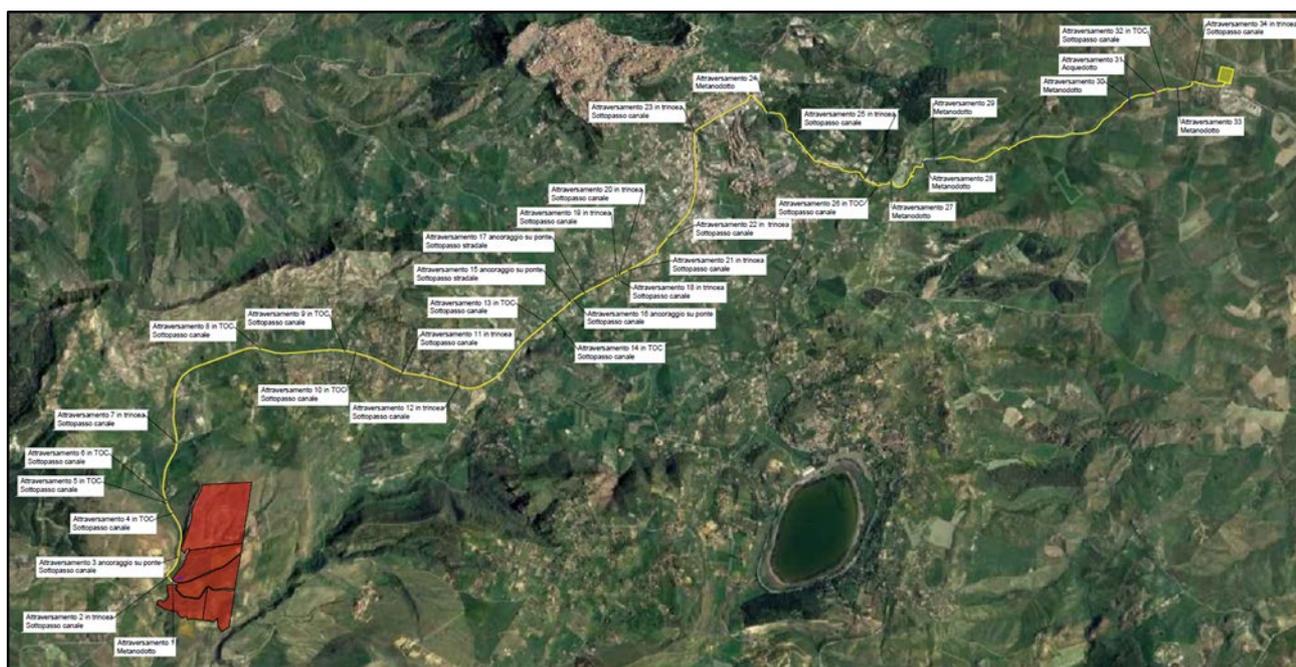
Estratto Elab.107 "Monografie sulle interferenze del cavidotto per la connessione dell'impianto" tracciato del cavidotto su ortofoto - ubicazione interferenze idrauliche
